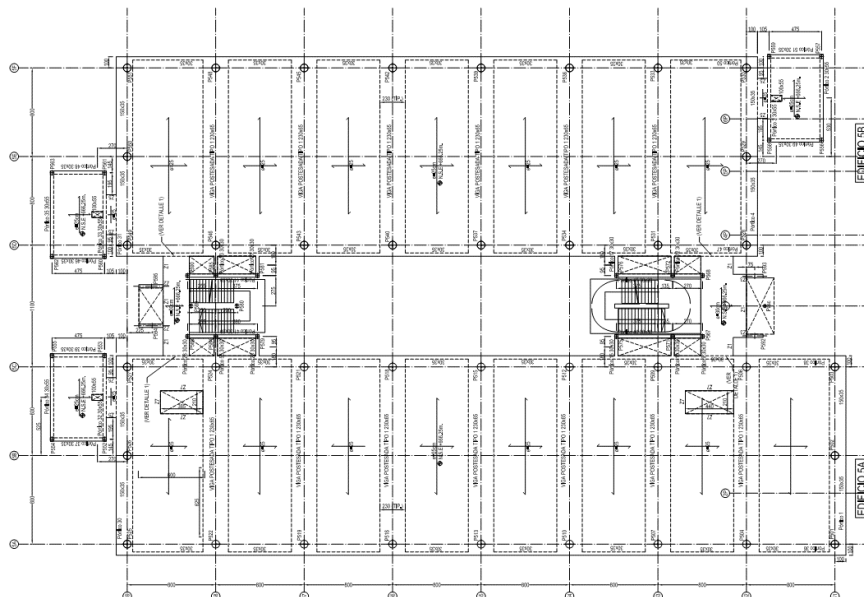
Planta tipo de edificio postesado 1,5 ó 7.
